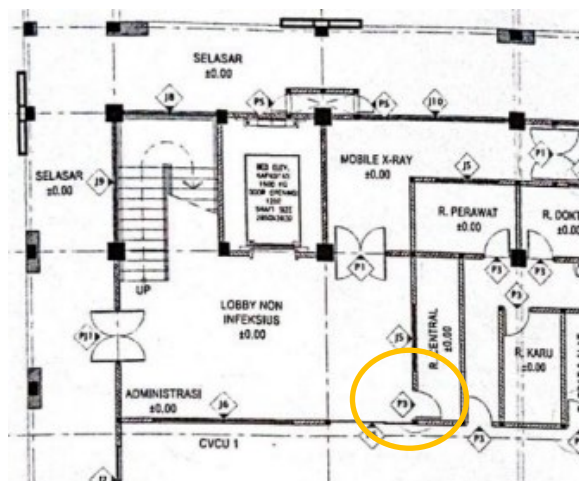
Denah Rencana Pintu Tipe P2.
